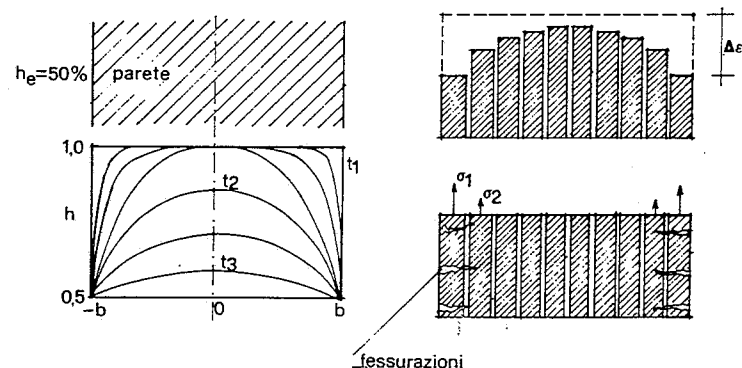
Parete di calcestruzzo in essiccamento
